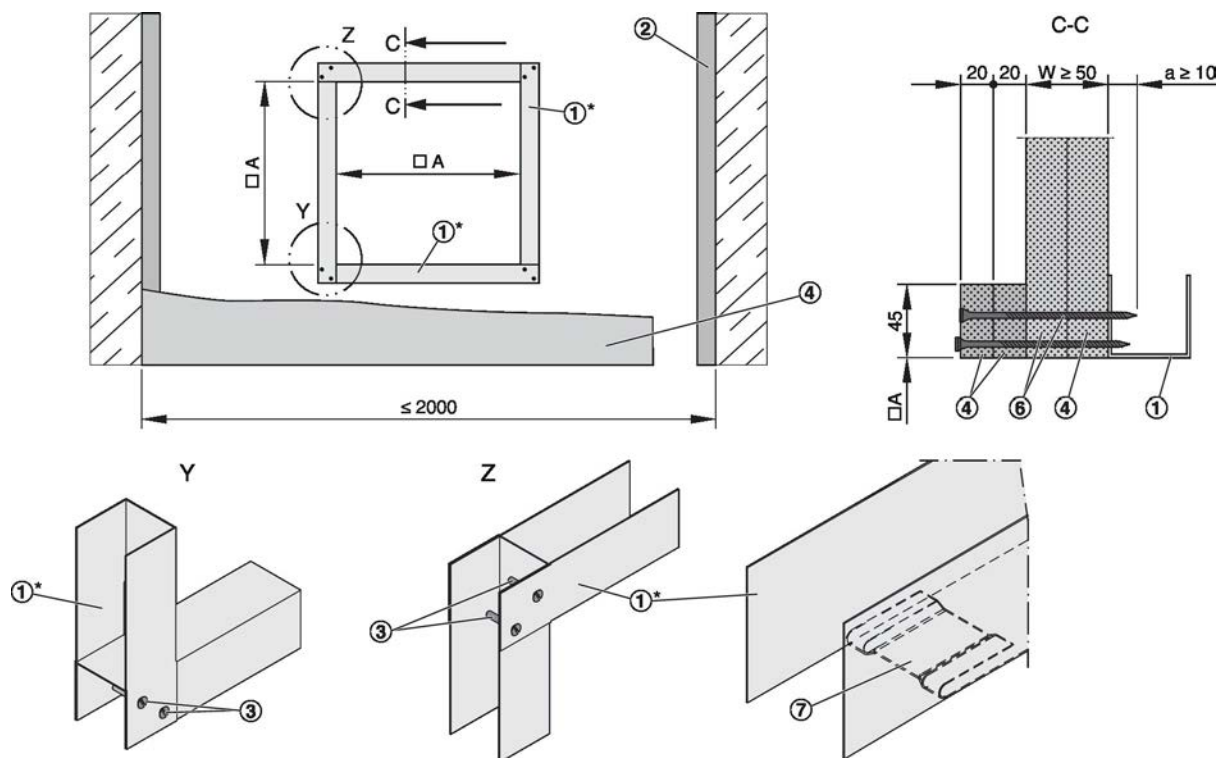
Patinillo sin estructura de pared metálica y aislamiento en un lado
